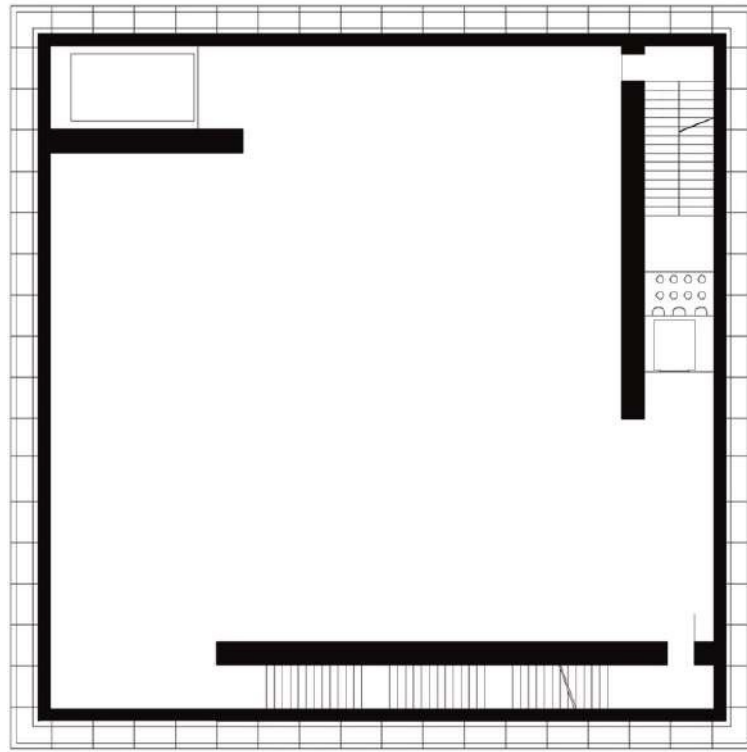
Planta piso 1, 2 e 3 do Kunsthhaus Bregenz
